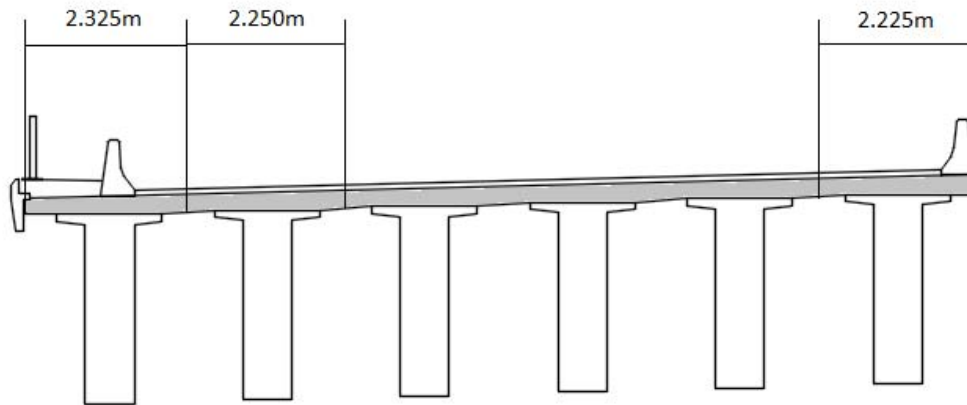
Dimensions des parties de dalle revenant aux poutres
